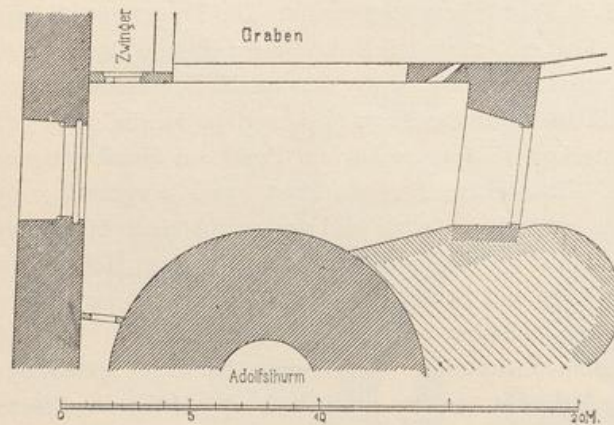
Das hintere Burgthor. Grundriss.
